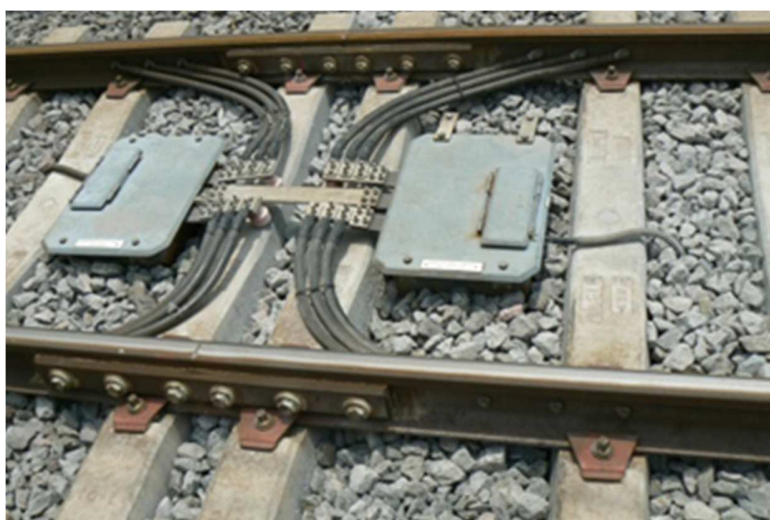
Juntas aislante pegadas con durmientes centrales inestables Pk 16,490 vía 1
